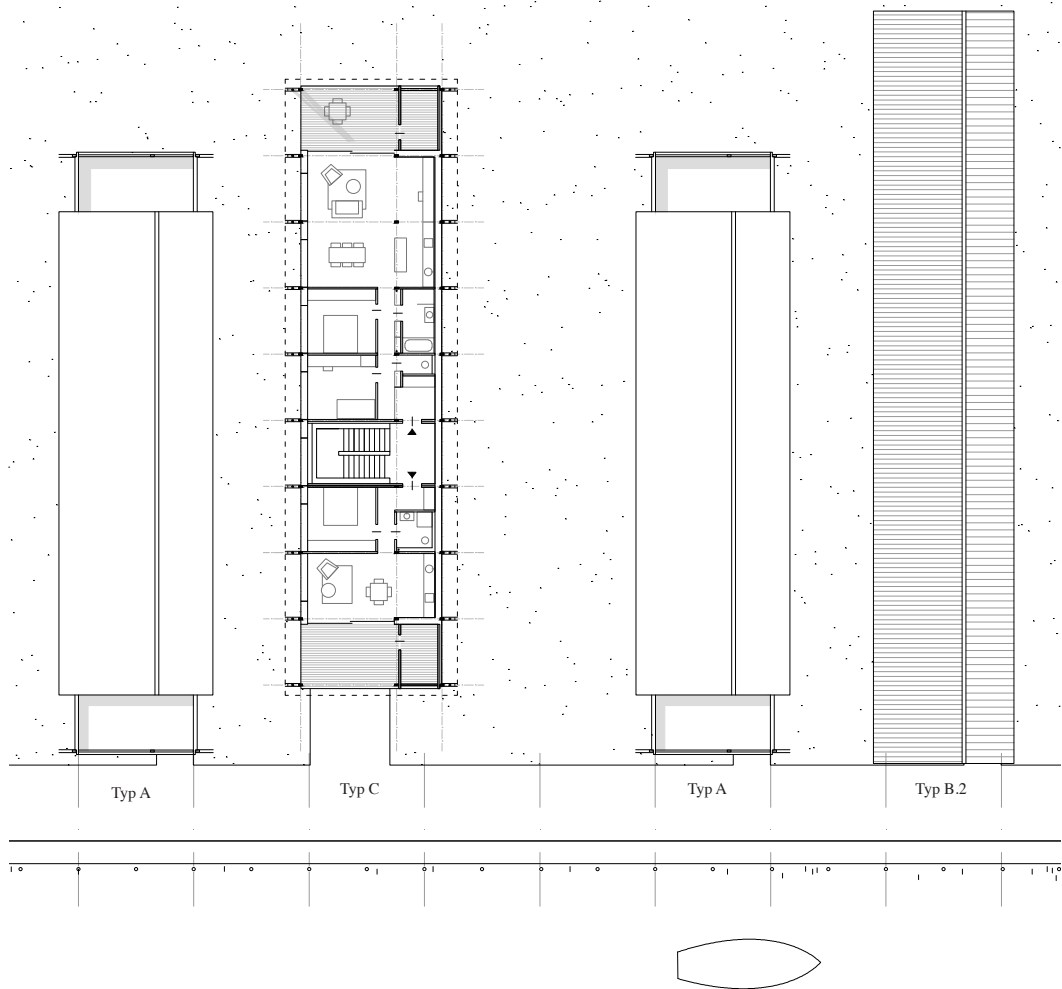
Ausschnitt Grundriss OG 1
